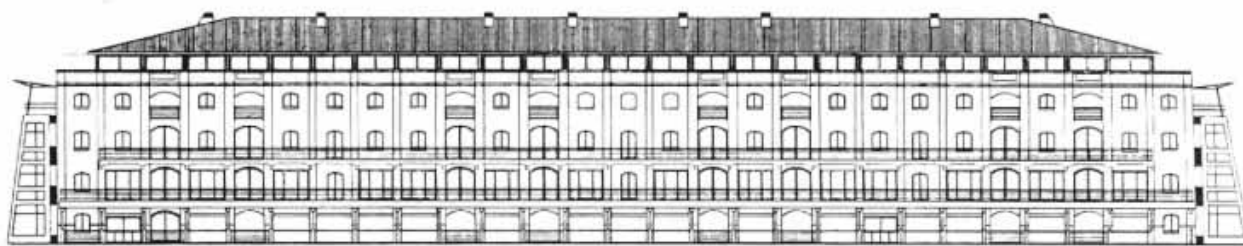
fachada leste Galpão 5. Fonte: Revista Arquis nº 1.
